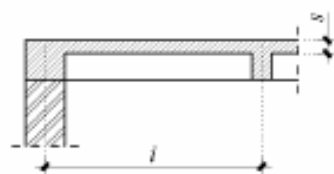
Solaio con soletta piena, travi primarie e travi secondarie
